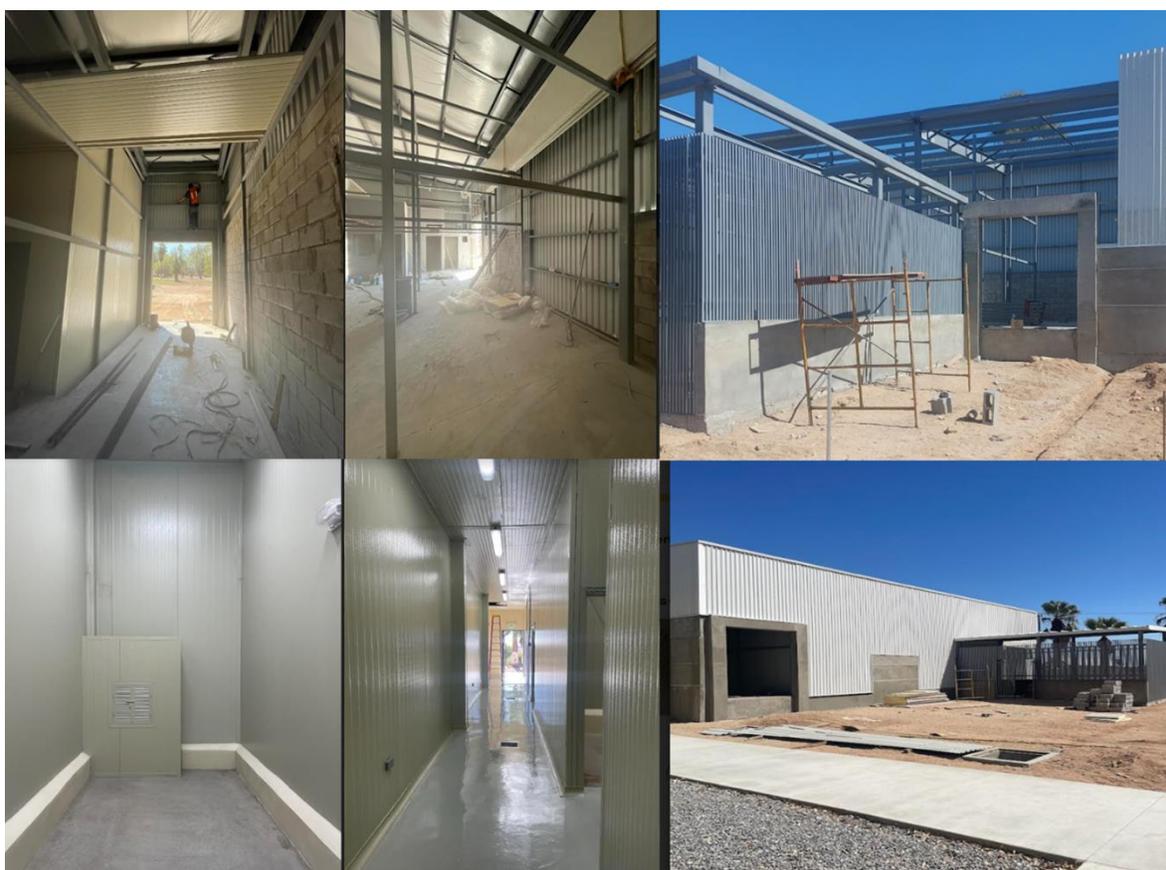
Construcción de la planta piloto para la producción de Malta
